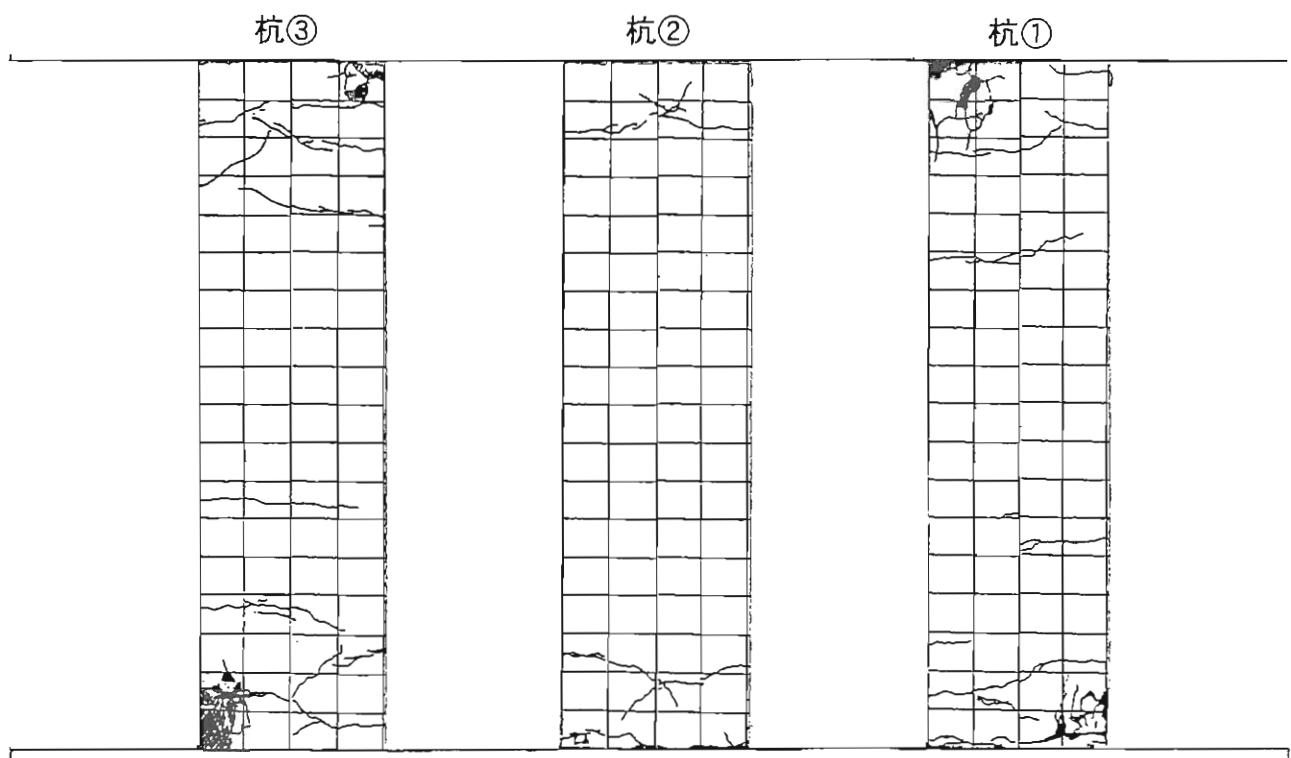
桁体のひび割れ状況展開図（ケース4、 $4\delta_y$ ）
